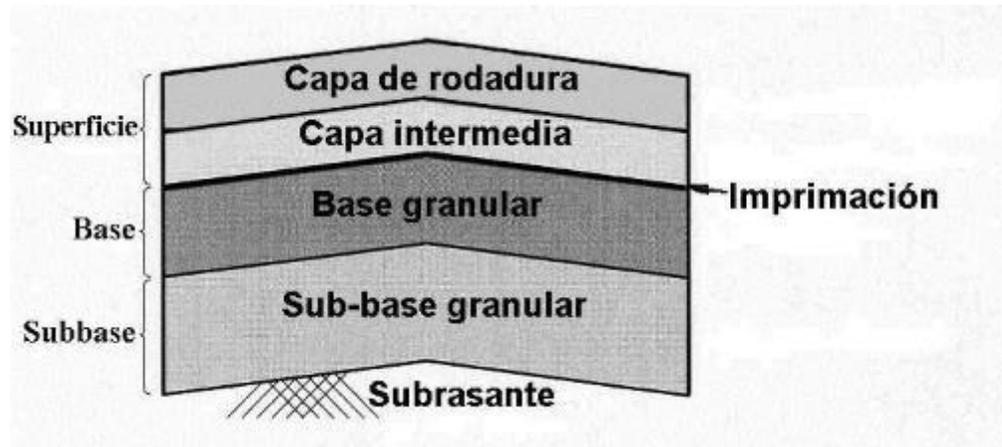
Estructura típica de un Pavimento (Fuente; <http://www.tresingenieros.com>)
